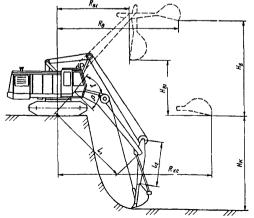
Рабочие размеры одноковшового универсального экскаватора с канатным приводом с рабочим оборудованием:
